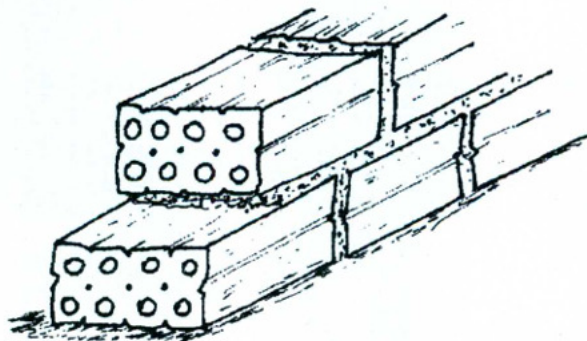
Execução de alvenaria de 1 vez, utilizando tijolos furados.
